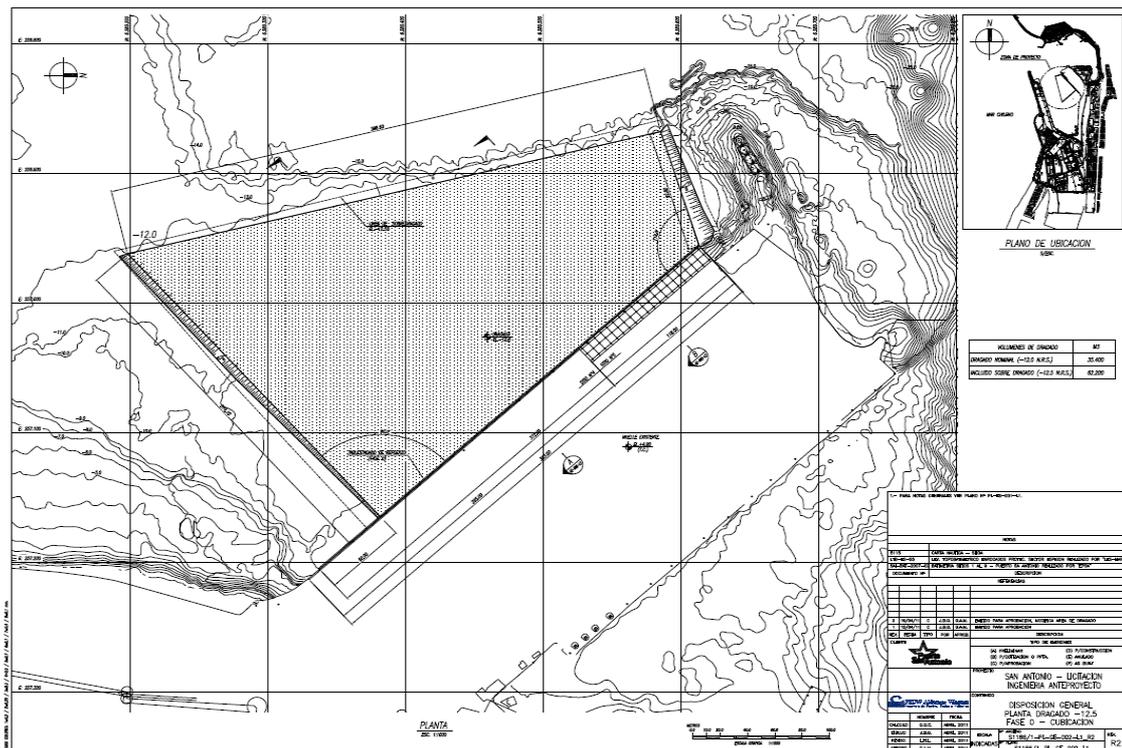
Fase 0 Planta de Dragados -12,5 NRS S1186/1-PL-GE-002-L1
